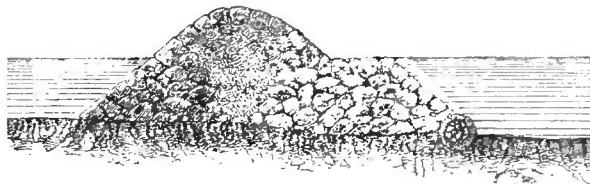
Section d'un épi en gravier revêtu de pierres.
